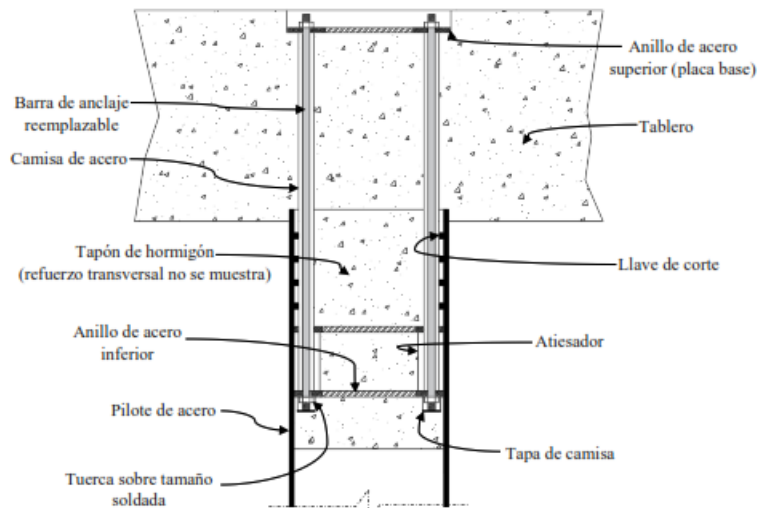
Detalle de conexión viga - pilote propuesta por Figueroa, F. (2017)
